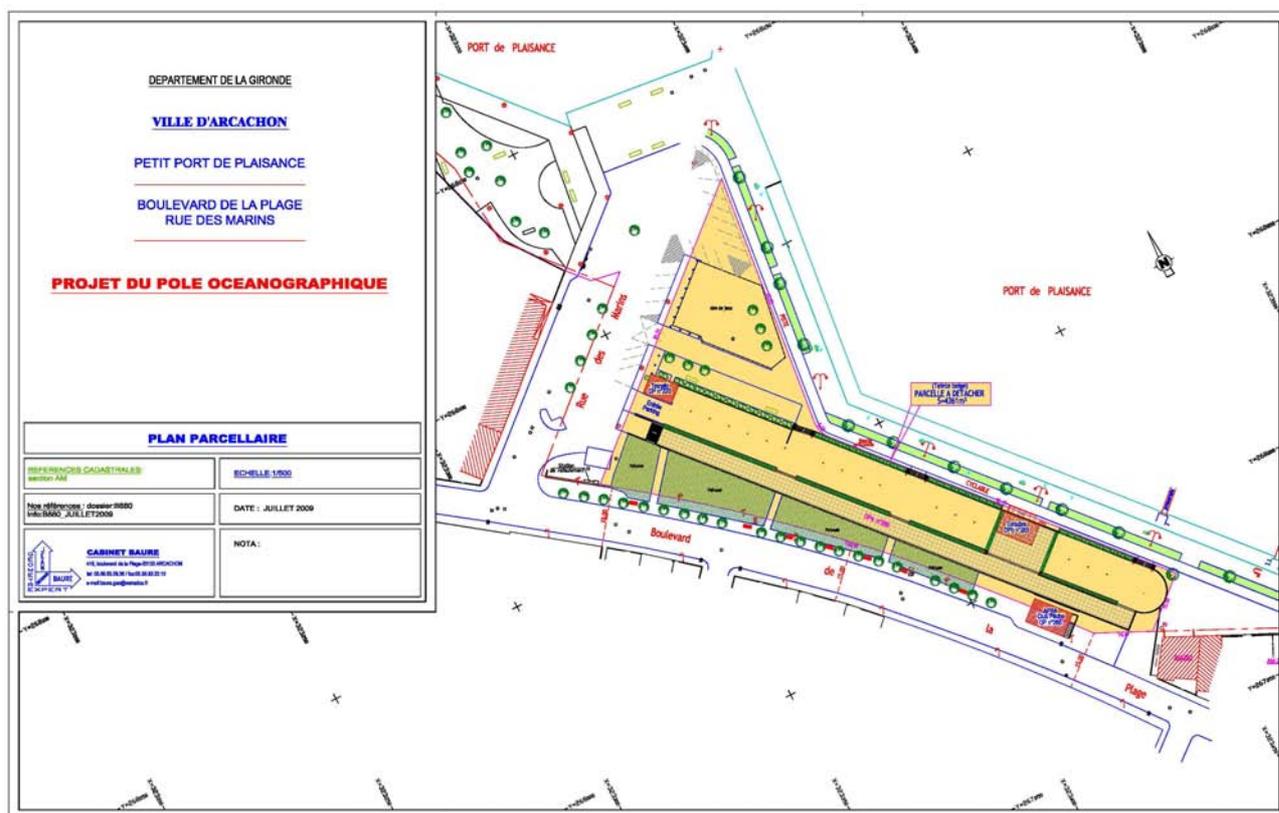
Plan parcellaire du site d'étude (Cabinet Bauré)
